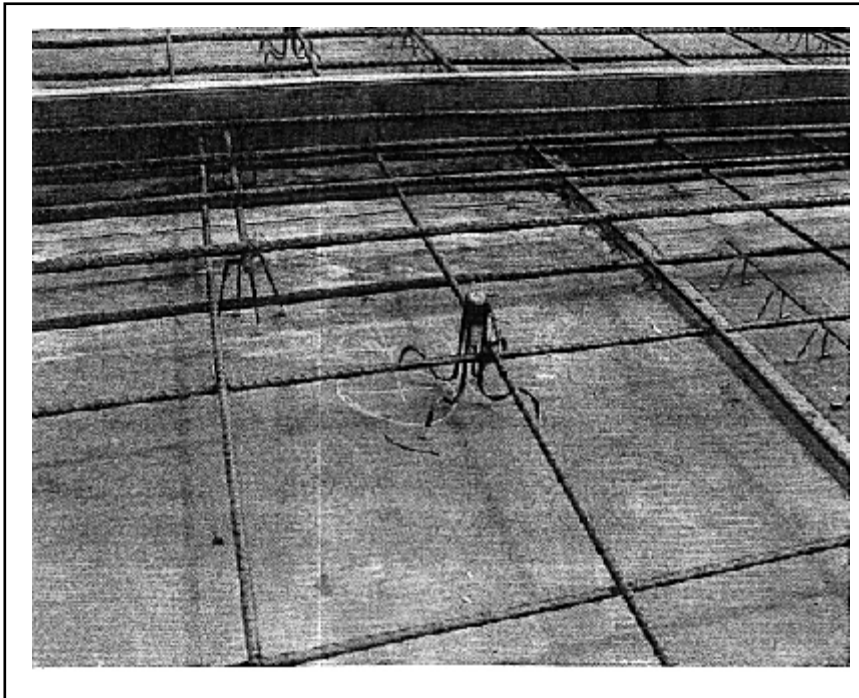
Colocación de acero de refuerzo en muros.
